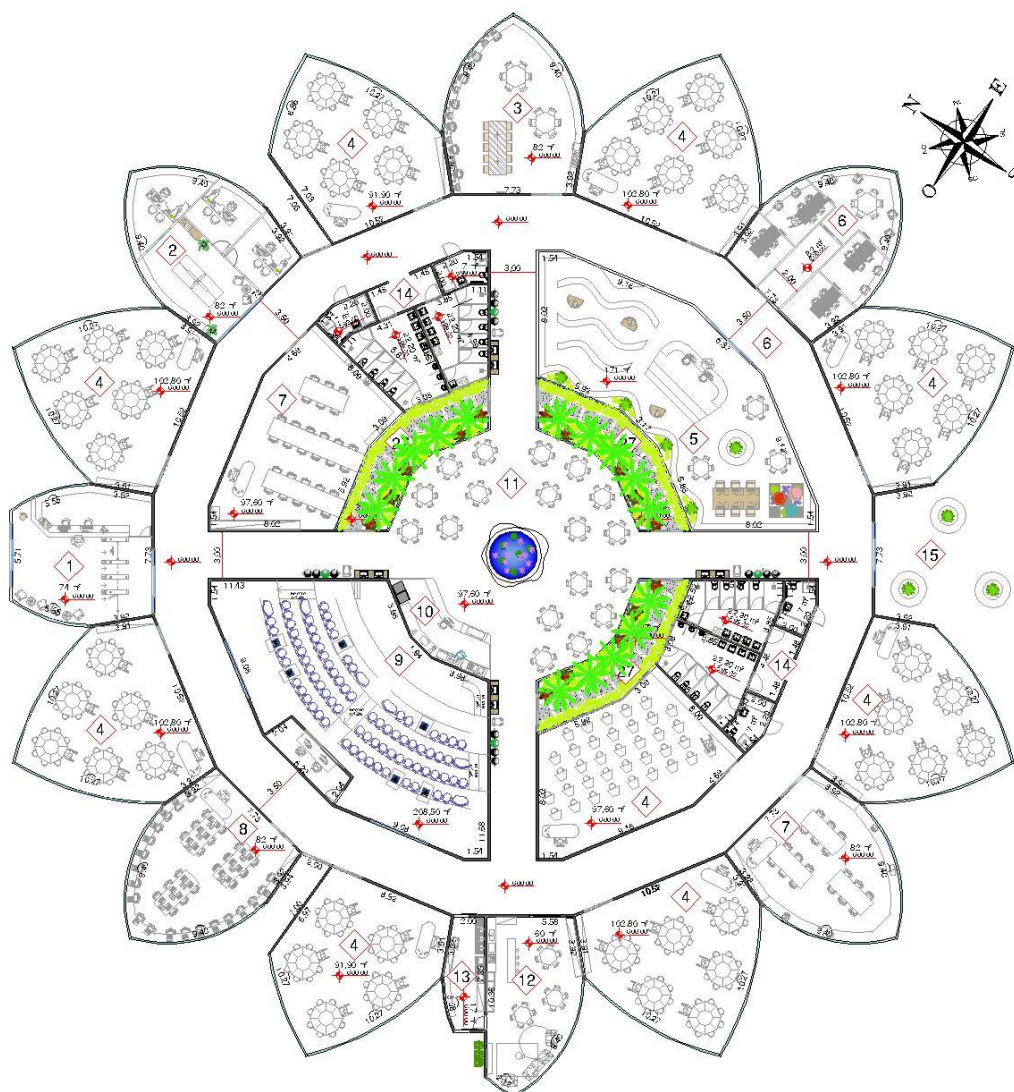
Planta Baixa. Fonte: Projeto da autora.
